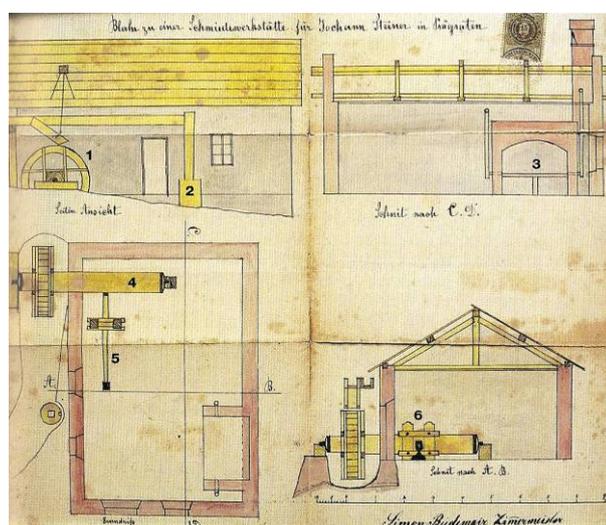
Grundriss einer mit Wasserkraft betriebenen Schmiede in Prägraten (Tirol): Oberschlächtiges Wasserrad (1), Wassertrommelgebläse (2), Esse (3), Daumenwelle (4), Schwanzhammer (5), Gerüststock (6).
